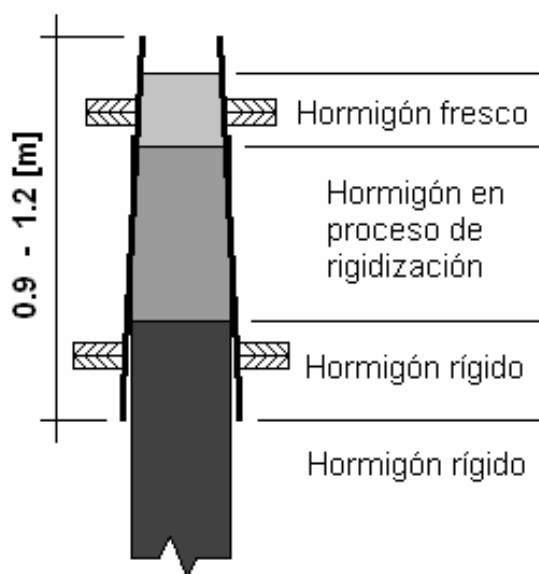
Gradiente de fraguado en moldajes deslizantes.
